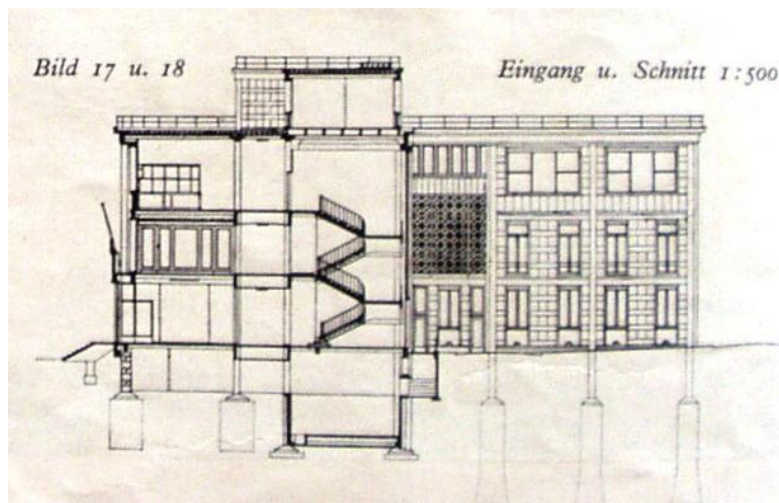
Schnitt des Marineministeriums. Die Fassaden wurden mit vorgefertigten Betonelementen geschmückt. Perret verwendete sie für Fenster und Attiken.
